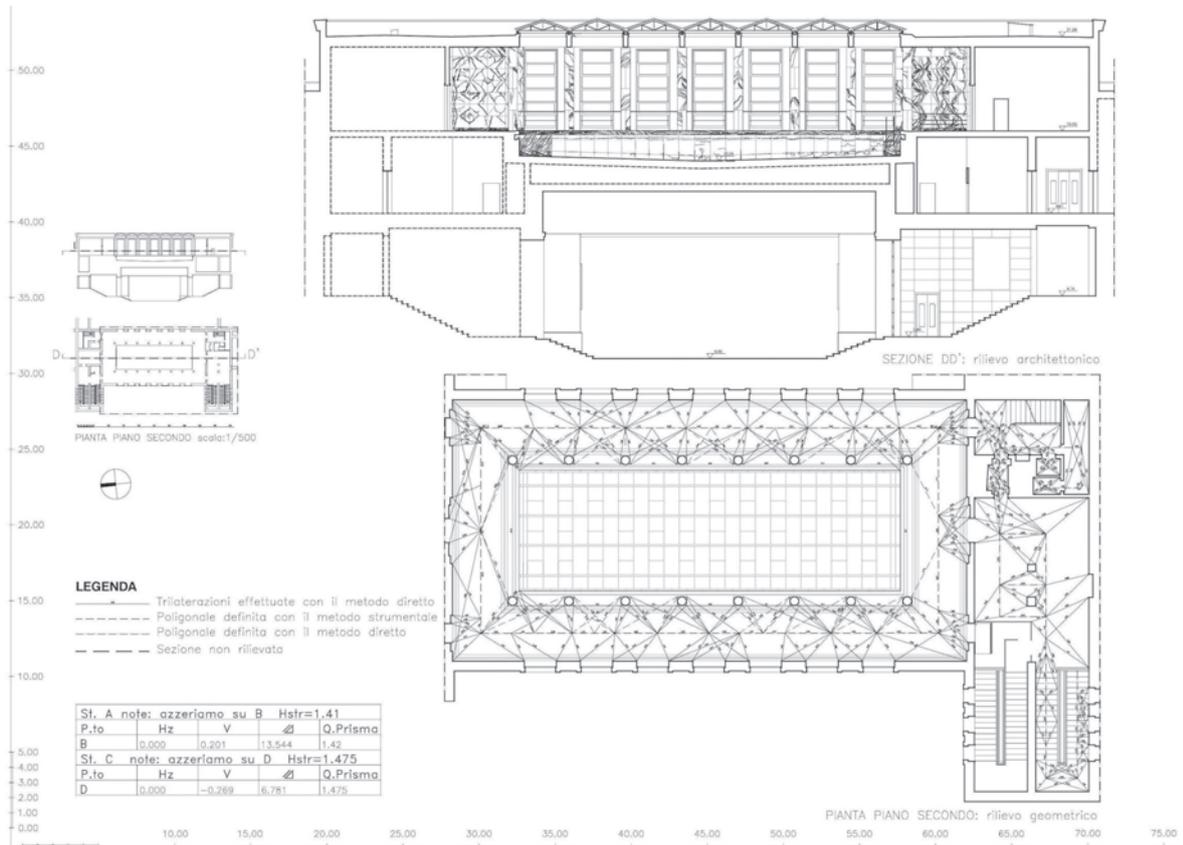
Levantamento arquitetônico da Piscina Pênsil, planta e perfil longitudinal.
